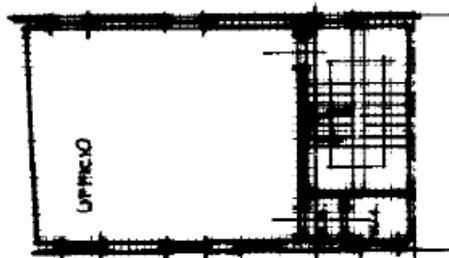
Estratto della planimetria catastale dell'ufficio posto al piano primo
